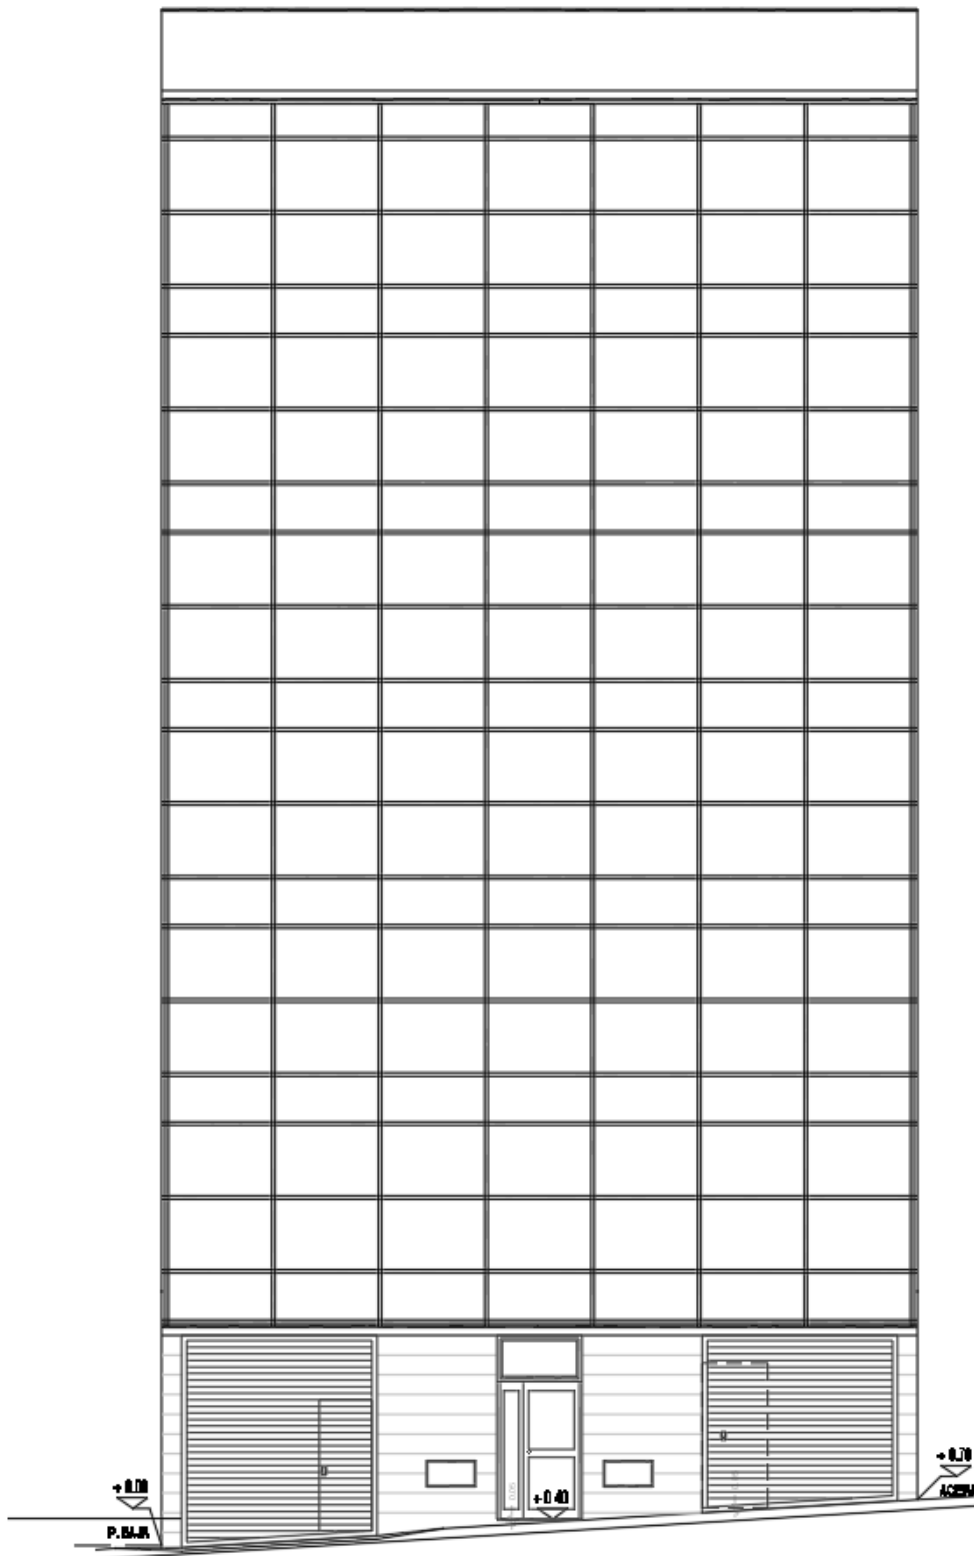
Propuesta de Fachada con Muro Cortina Fuente:Propia
